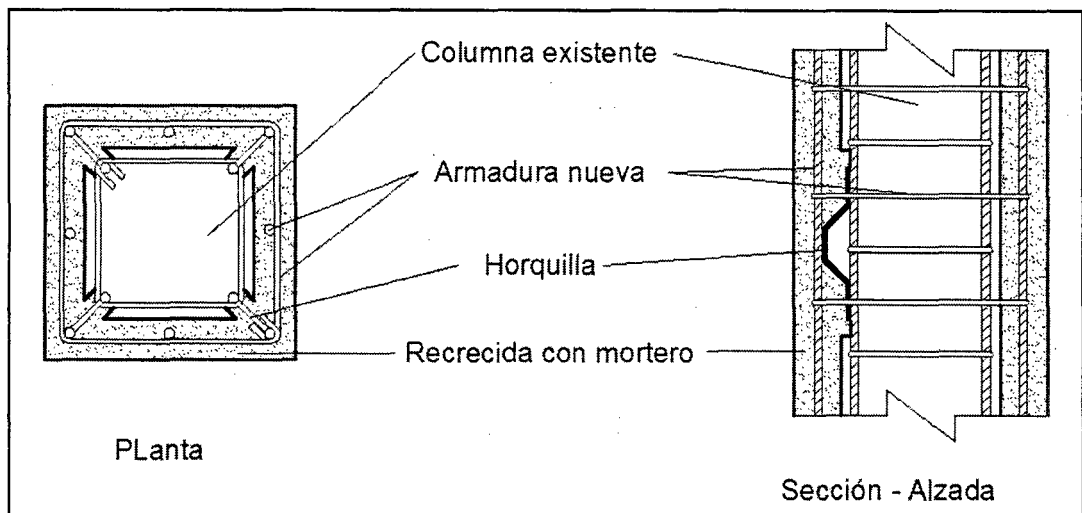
Recrecido con concreto armado por conexión de horquillas.
